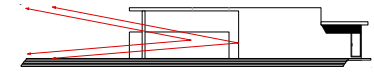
Vistas predominantes hacia el horizonte. Fuente: Autor.
